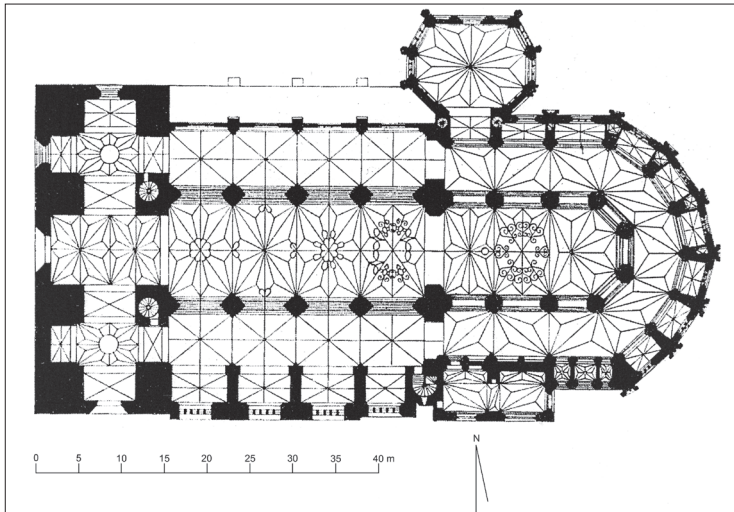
Stargard St. Marien, Grundriss
